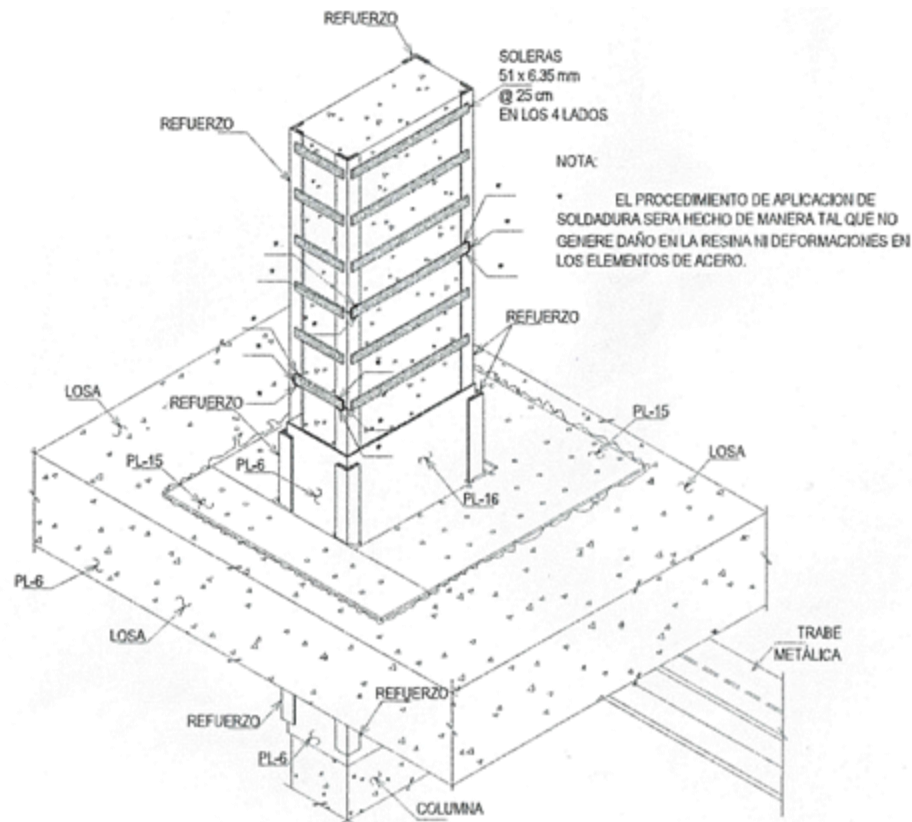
Encamisado de las columnas tipo C-3 y C-3'-R-2, restauración del Edificio G, UAM.
